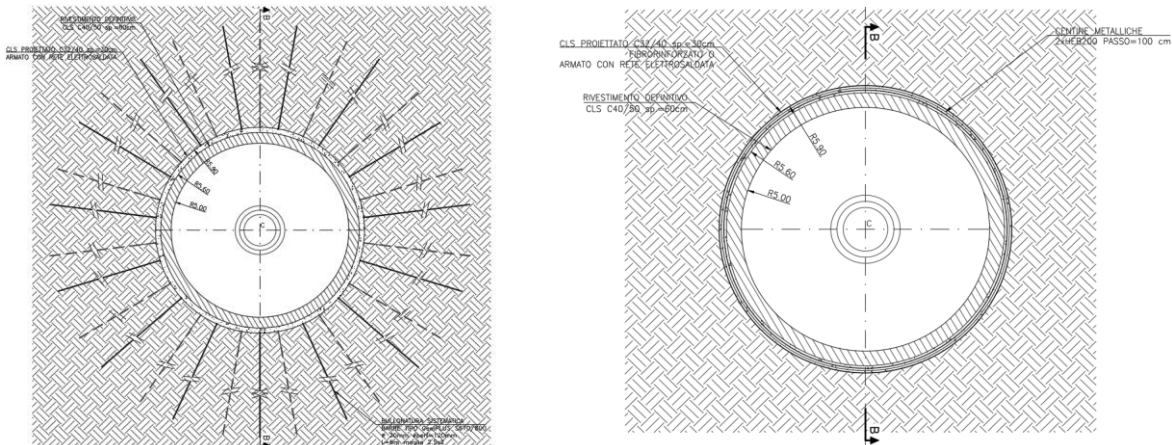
Sezioni tipo P\_Piez2 e P\_Piez3
